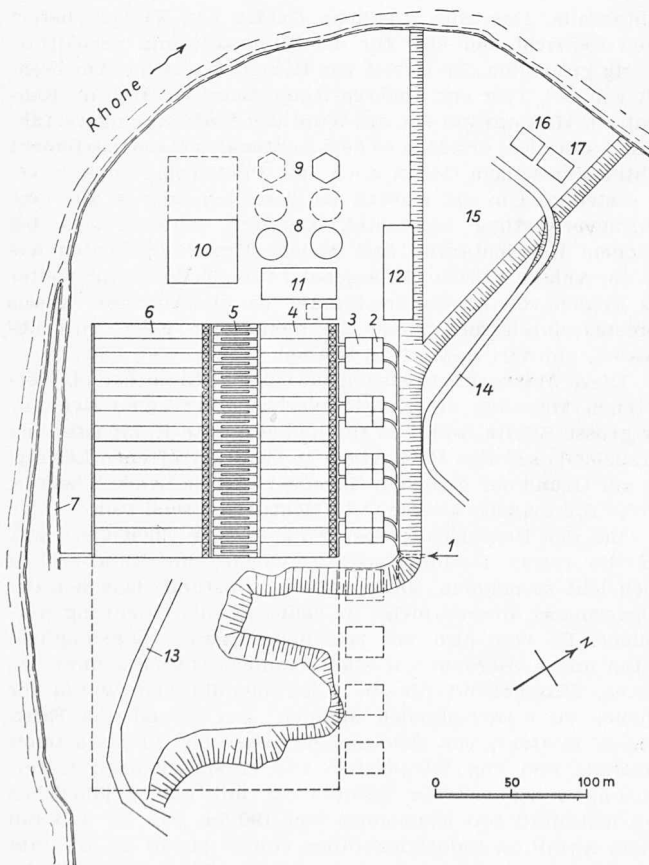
Lageplan der biologischen Kläranlage Aire, 1:5000
